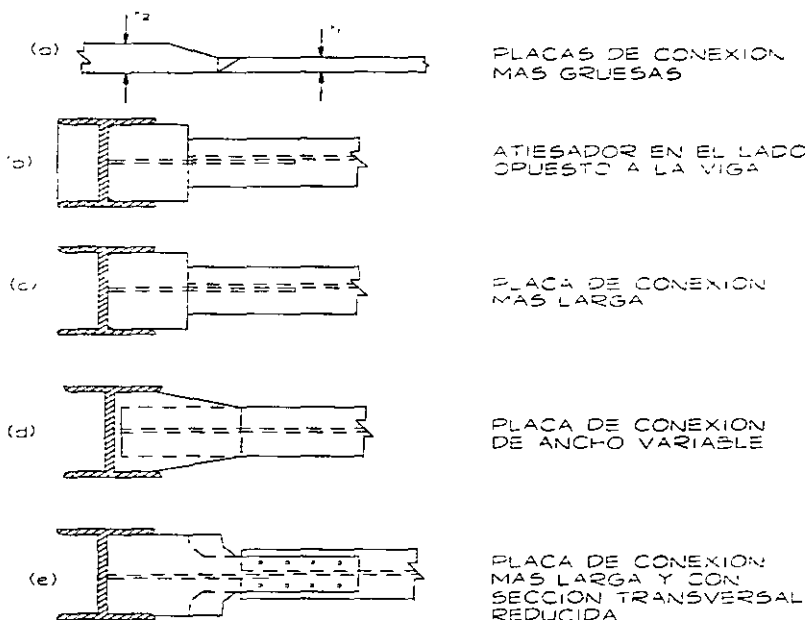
Medidas para mejorar el comportamiento de juntas con Vigas unidas al alma de la columna
